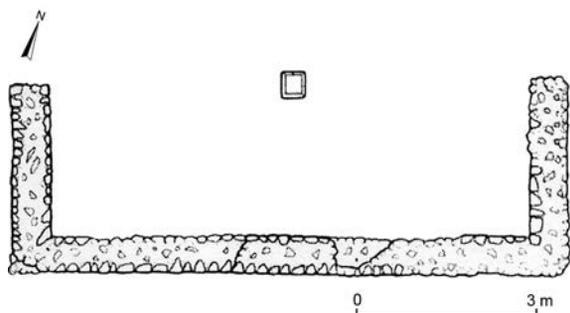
Plan du bâtiment E (d'après Rober, 1983).
